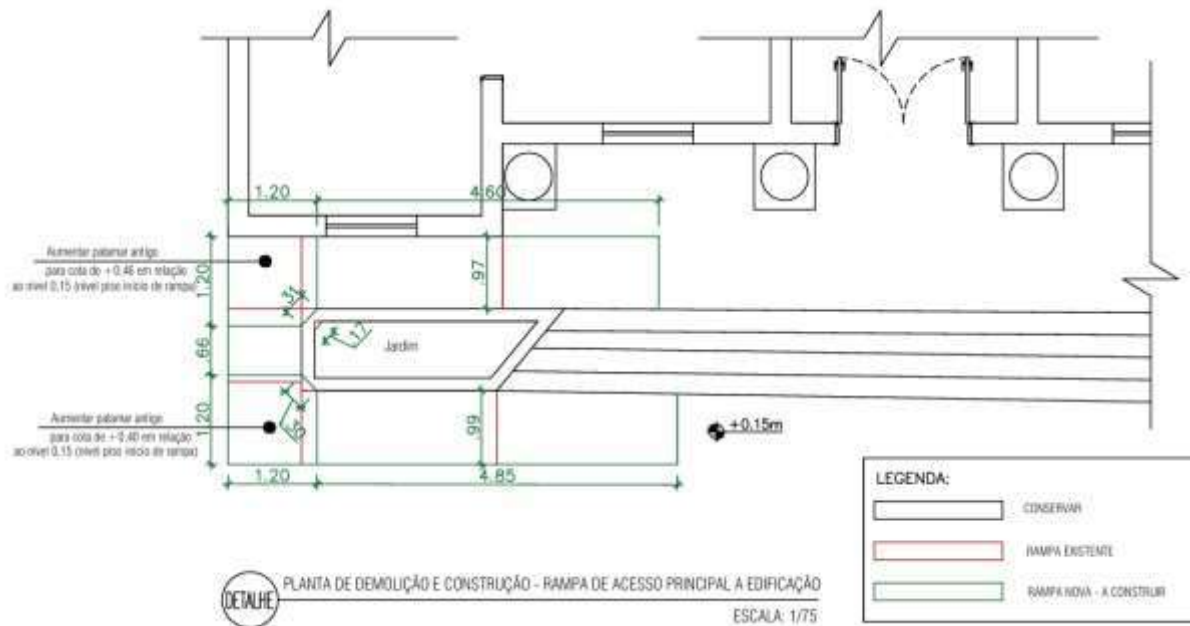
Planta de reforma para adaptação da nova rampa (sem escala)
